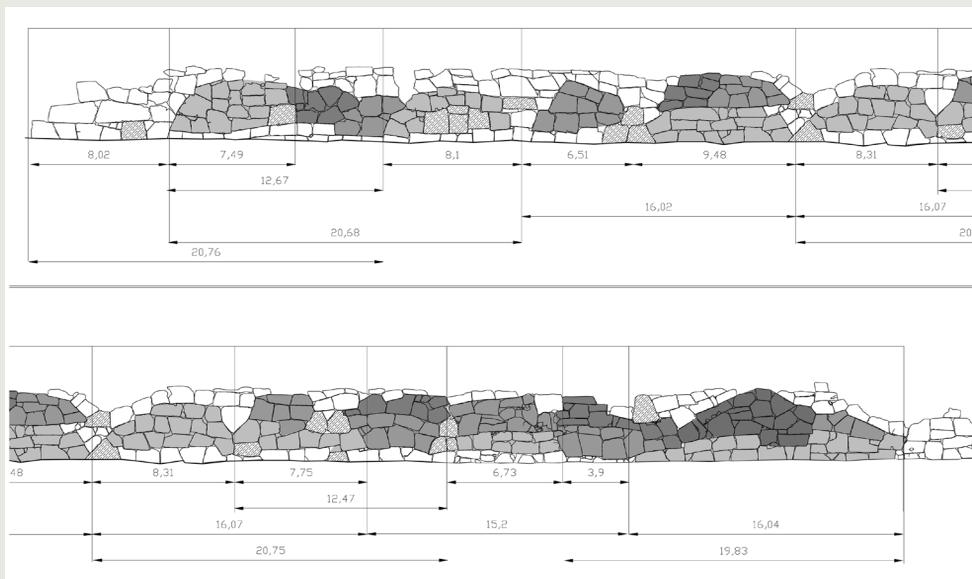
Mura poligonale di Pyrgi, lato nord. Individuazione dei lotti di cantiere (archivio Sapienza, elab. B. Bellelli Marchesini).
